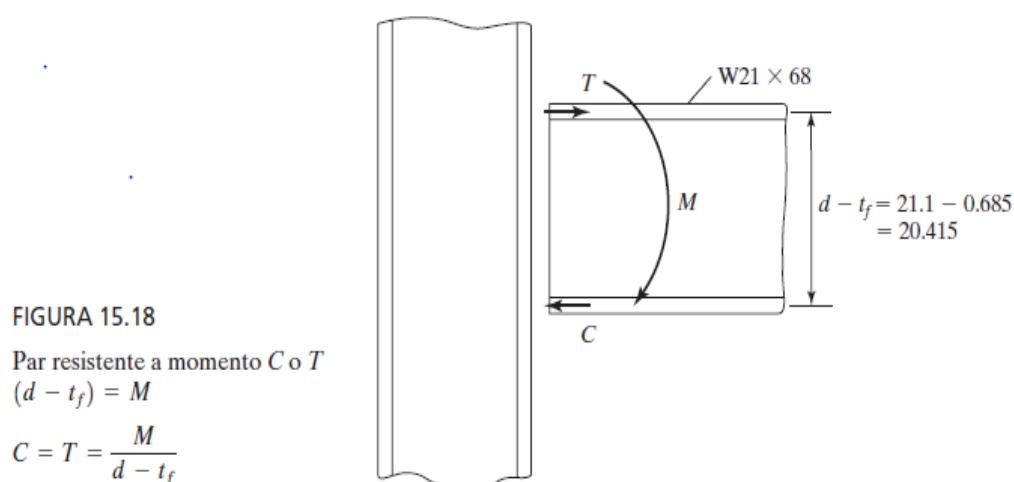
Cálculo de fuerzas de Compresión - Tracción en vigas
